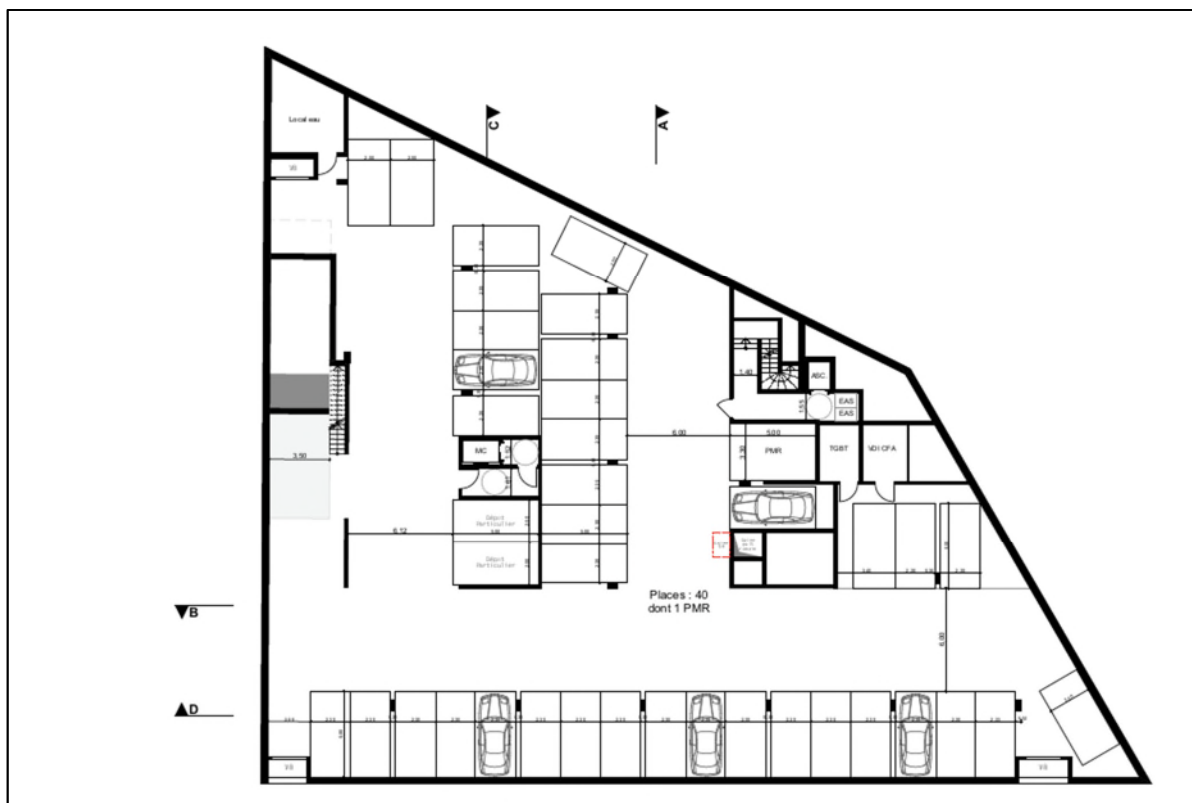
Plan masse du sous-sol – BY Bâtiment APS
